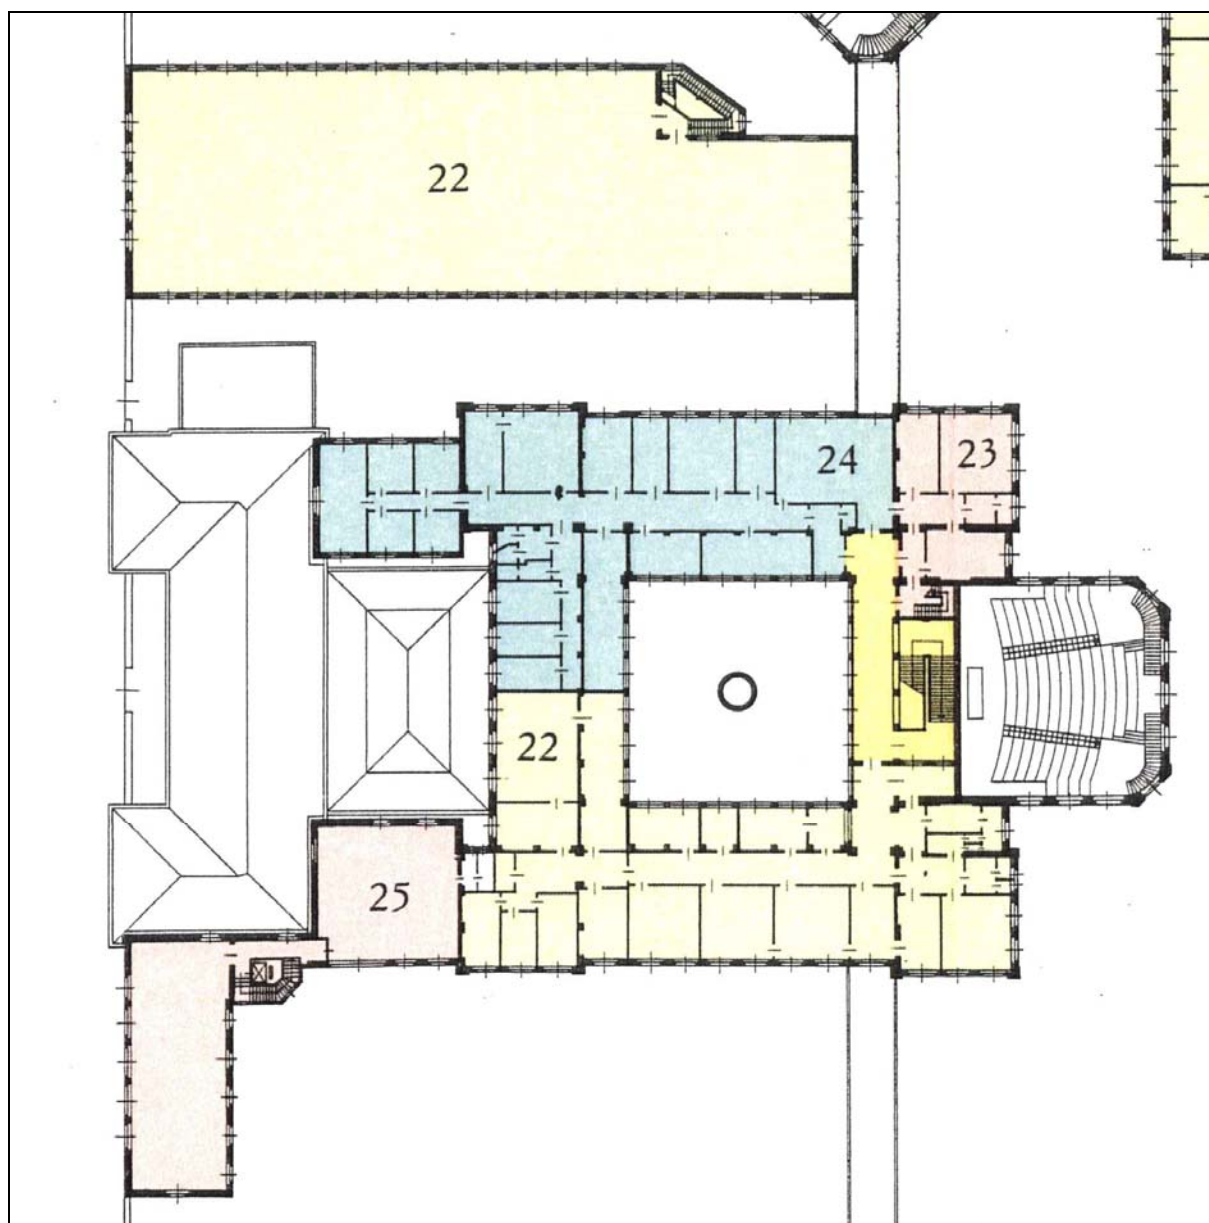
Planimetria del Primo Piano ED 4 e ED 10 (1963)
